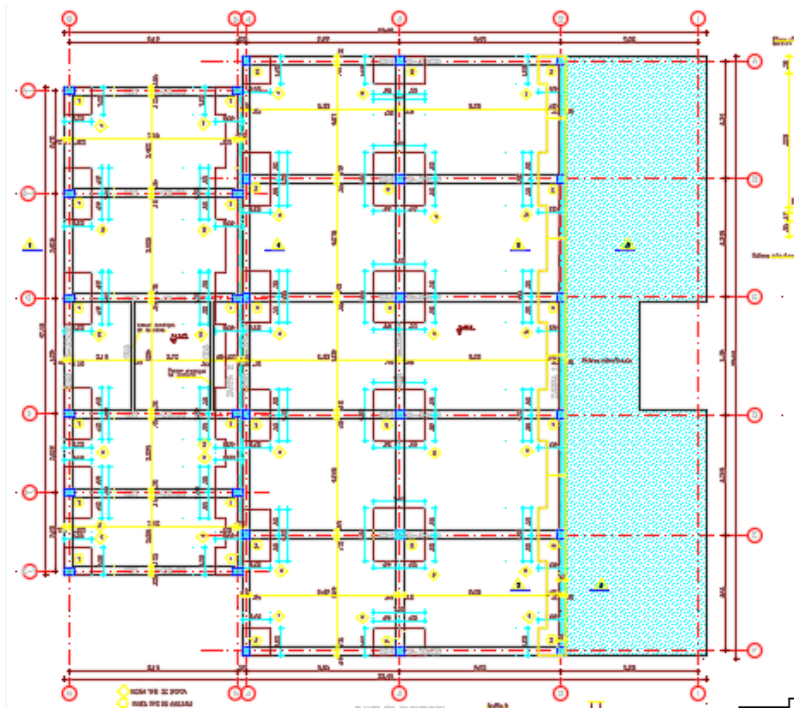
Esquema general en planta de cimentación actual nivel -3.80 m. Fuente: Propia
